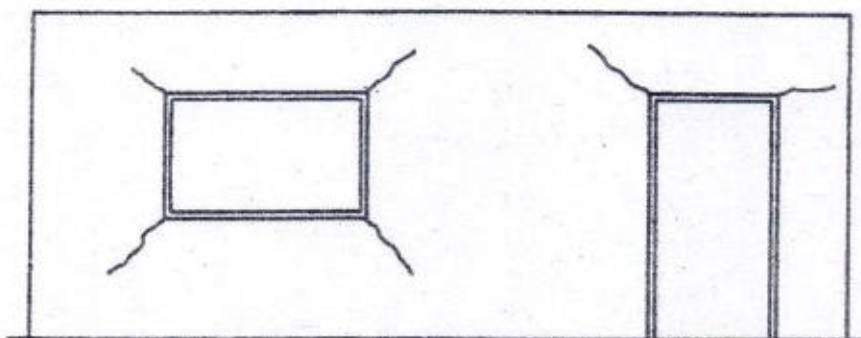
Fissuração típica (real) nos cantos das aberturas, sob atuação de cargas
